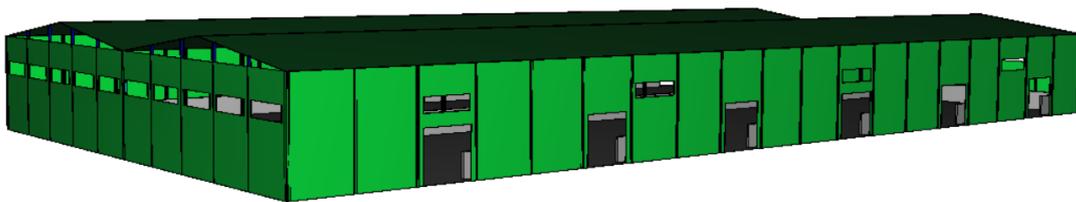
Prospetto del capannone eseguito con PyroSim
